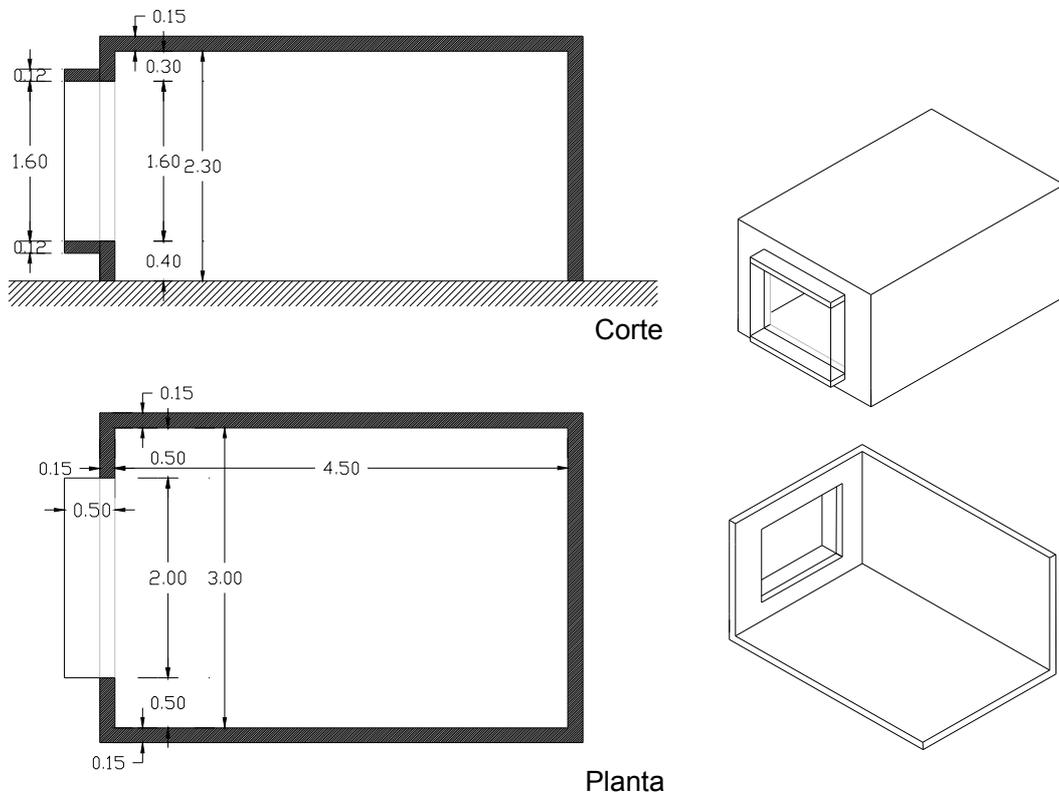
Localização e dimensões da “Janela em Sacada”, mostradas em corte longitudinal, planta e isométrica externa e interna.
